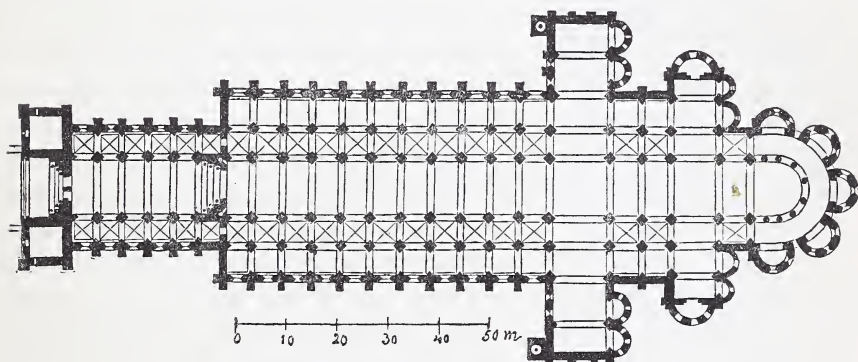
Grundriss der Abteikirche zu Cluny.
